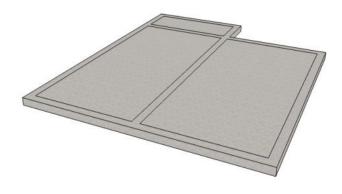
Fase 1: Replanteo y elaboración de platea de hormigón. Fuente: Elaboración Propia.
